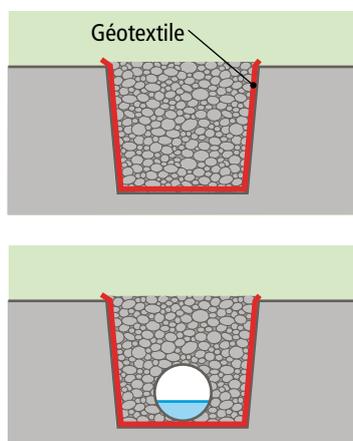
Conduite de drainage, en bas avec tuyau de drainage
